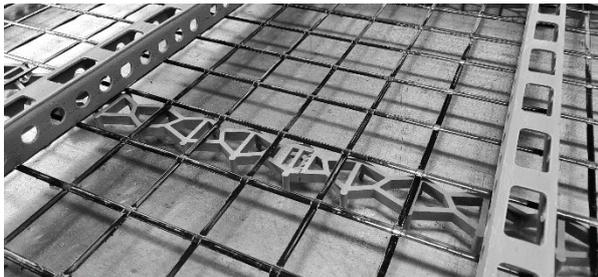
Bewehrungsgitter mit Kunststoff-Abstandhaltern und Fuß aus Faserbeton
